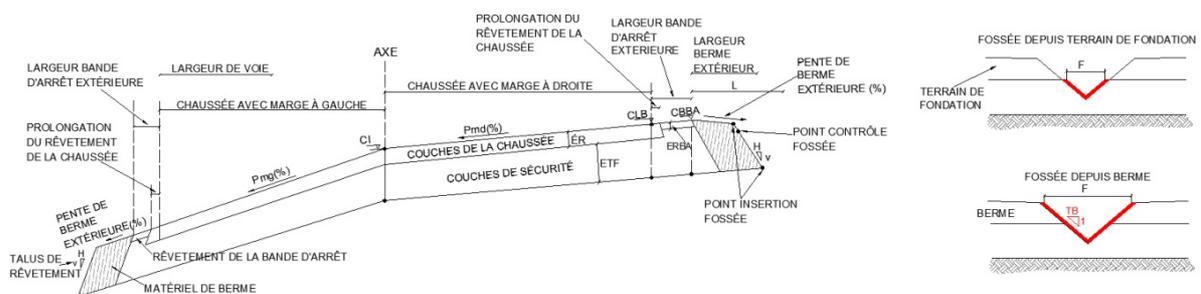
Section type simple (surhaussements transversaux en escalades)
